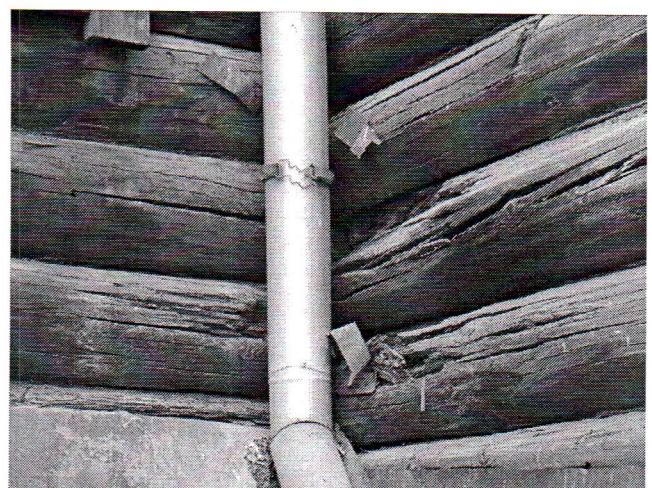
, 9. Поражение гнилью нижних венцов на внутренних углах сруба на северном фасаде.
